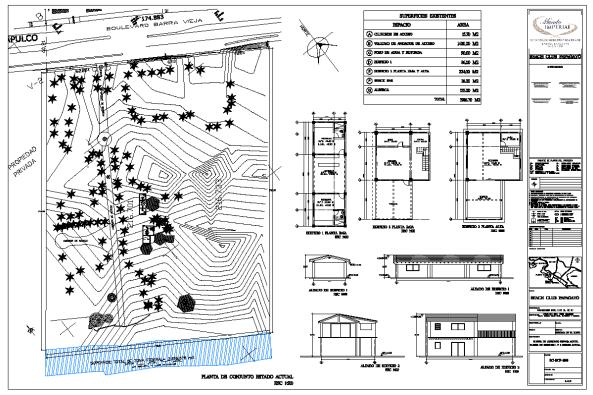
Planos de conjunto arquitectónico. (Ver anexo N°4 Plano del Proyecto).
